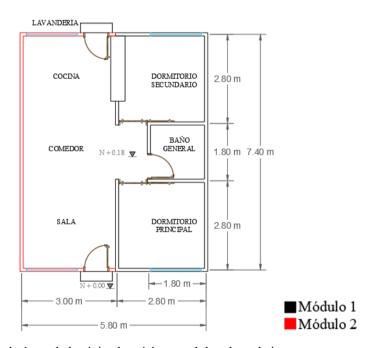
Distribución de áreas de la vivienda mínima modular planta baja.
